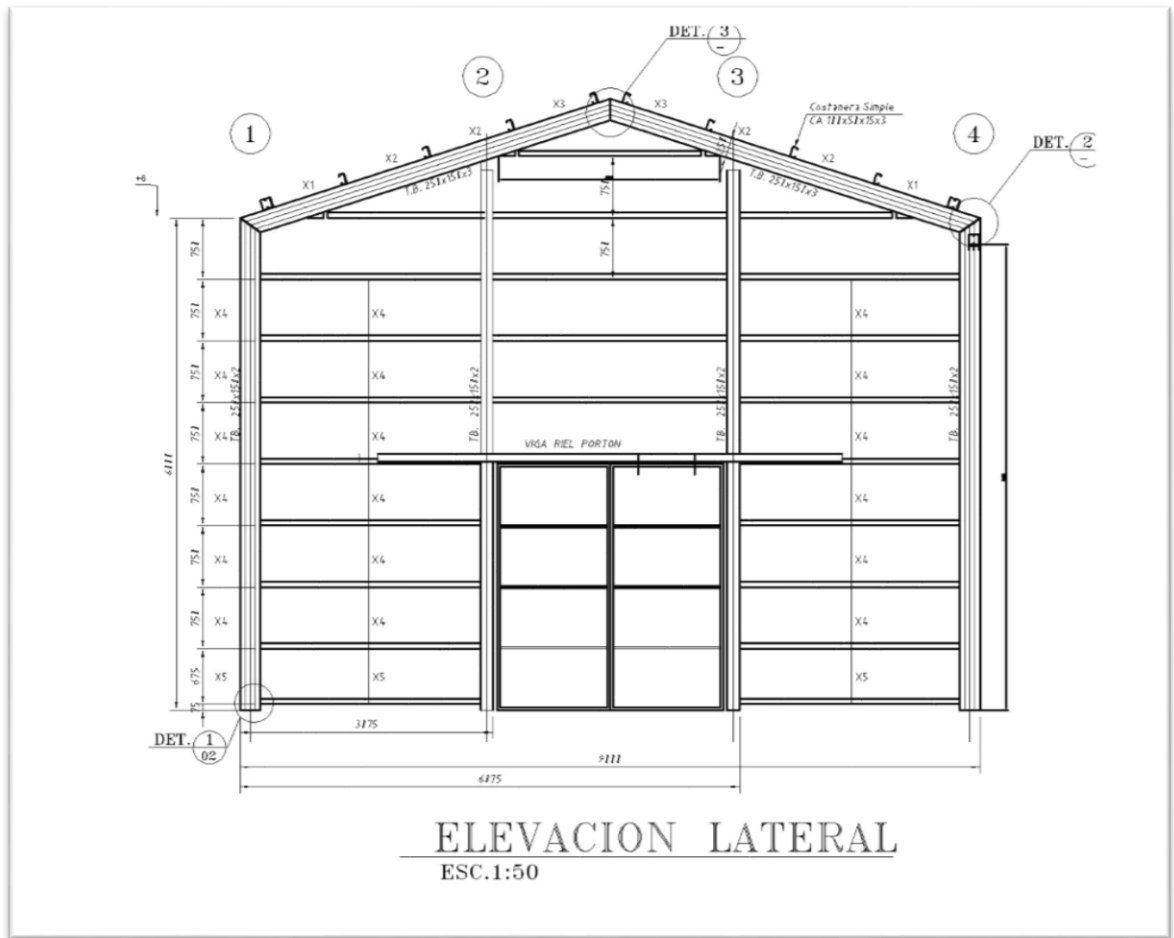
2: Planta elevaciones nave 12x9 para almacenamiento de materiales
